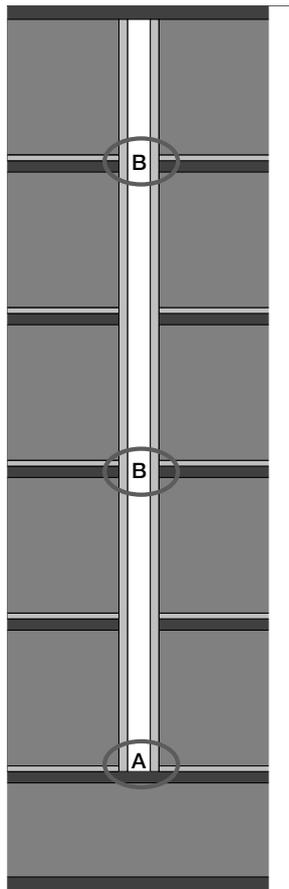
Installationsschacht mit einer Brandlast im ganzen Schacht = 3160 MJ (bei fünf Stockwerken; Standard-Belegung)
